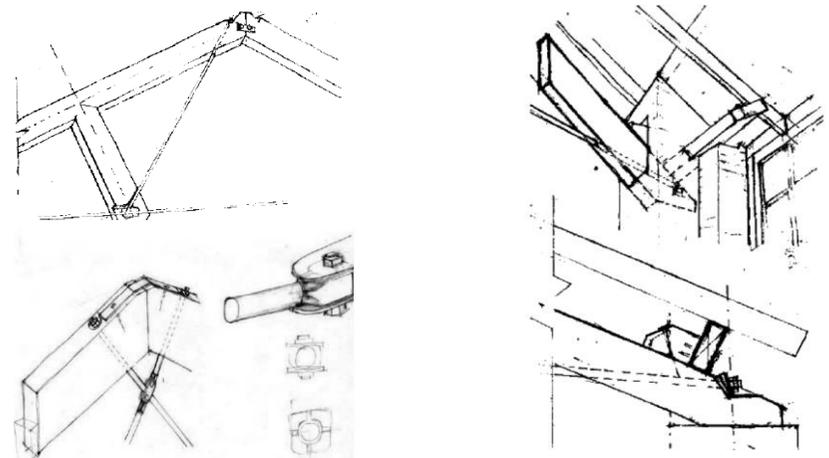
(izq.) Croquis de 2 tipos de cercha polonceau mixtas con pares de madera. Fuente: UPM
